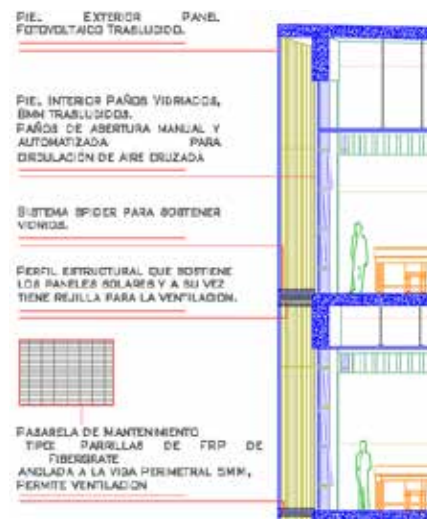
Plano Detalle de Corte de fachadas de doble vidrio de las Aulas de clase. (2017).
